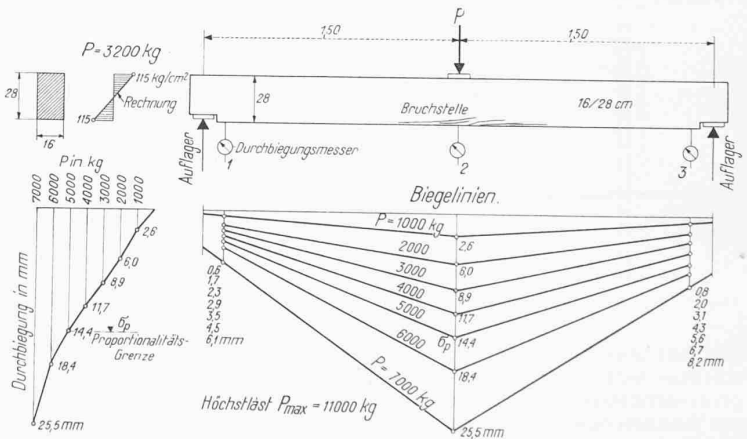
Laboratoriumsversuch mit Balken auf zwei Stützen
